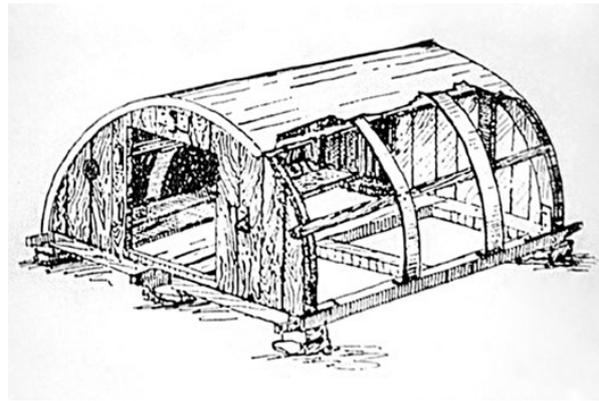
| Prima raffigurazione prototipo bivacco tipo - Ravelli
